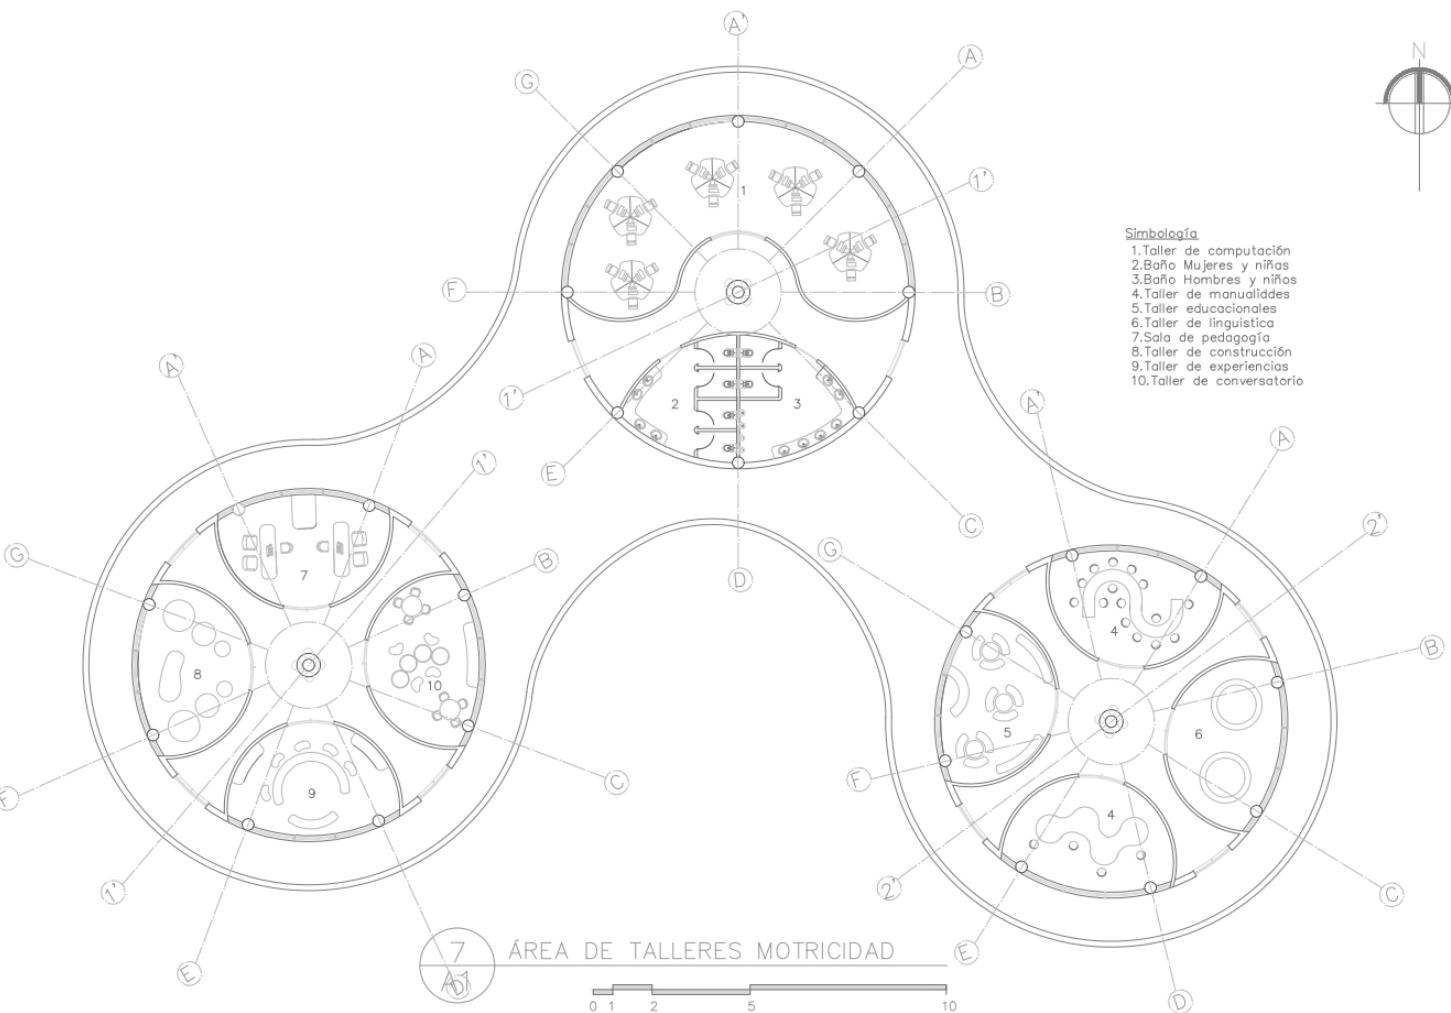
Planta Arquitectónica Zona de Talleres de Motricidad
